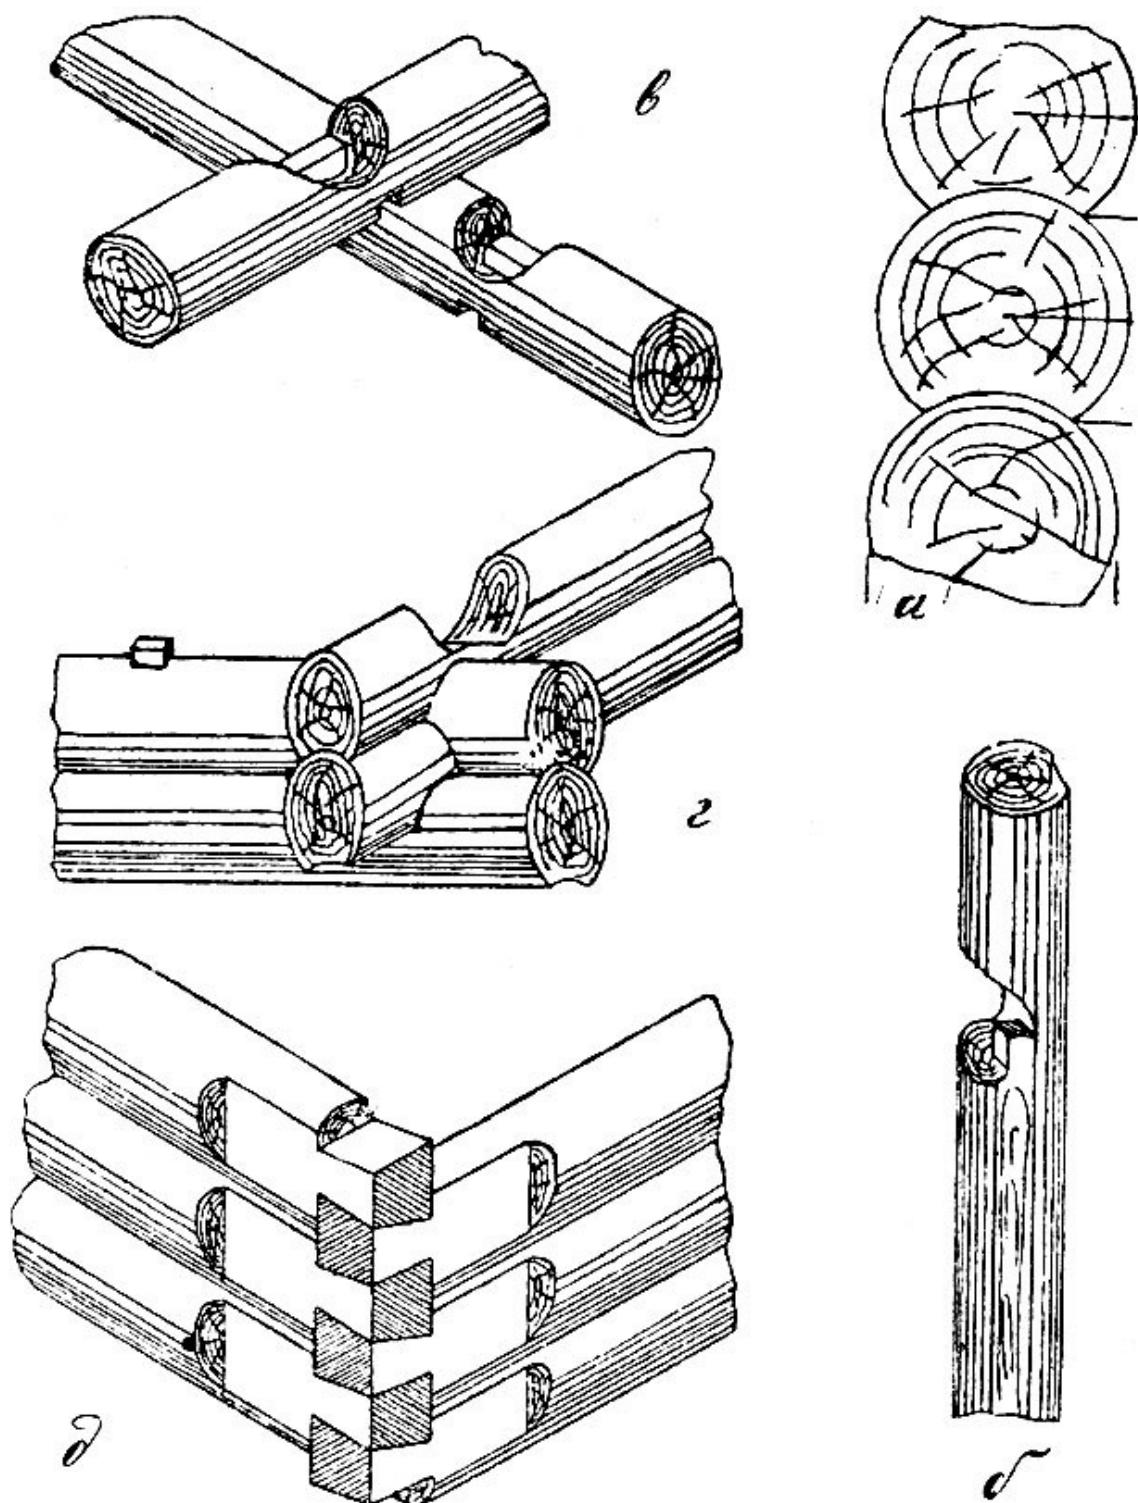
Устройство сруба, а – вид пазов в разрезе; б – вид вырубки – 'чашки'; в – как накладывать бревна сруба; г – общий вид сруба, складываемого в чашку с остатком; д – другой возможный вариант кладки сруба
